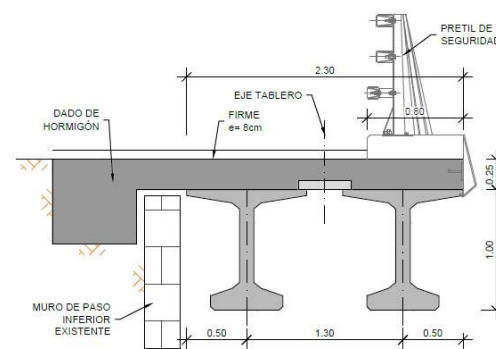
Sección transversal. Estructura E-5. Alternativas 1A, 1B y 3A
